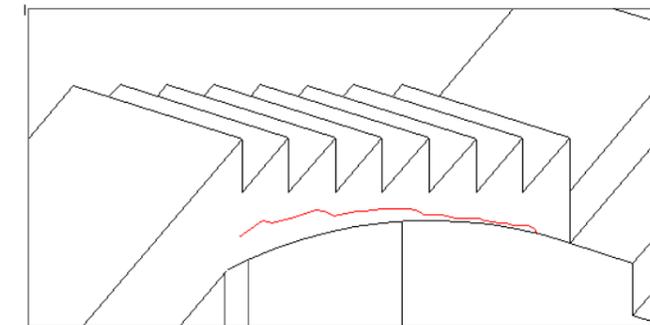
grieta en bóveda escalera. Fuente: autor propio
